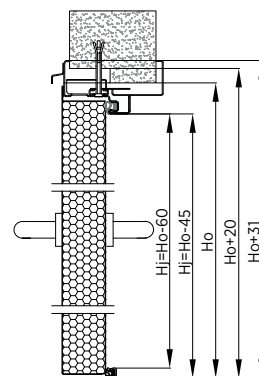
Pose au mur - bloc-porte à deux vantaux - bâti enveloppant à rupture de pont thermique - coupe verticale
